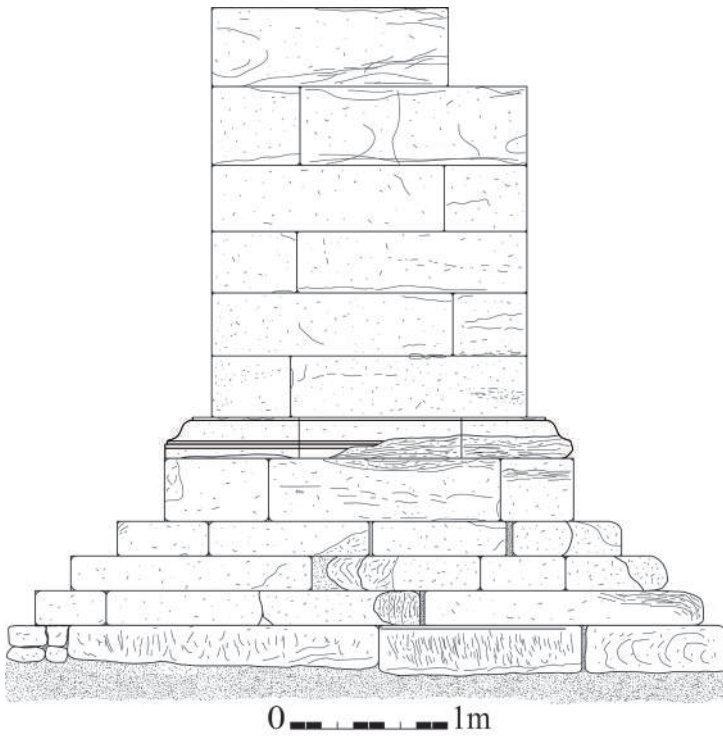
Élévation de la façade ouest du mausolée de Henchir El Ksar.
